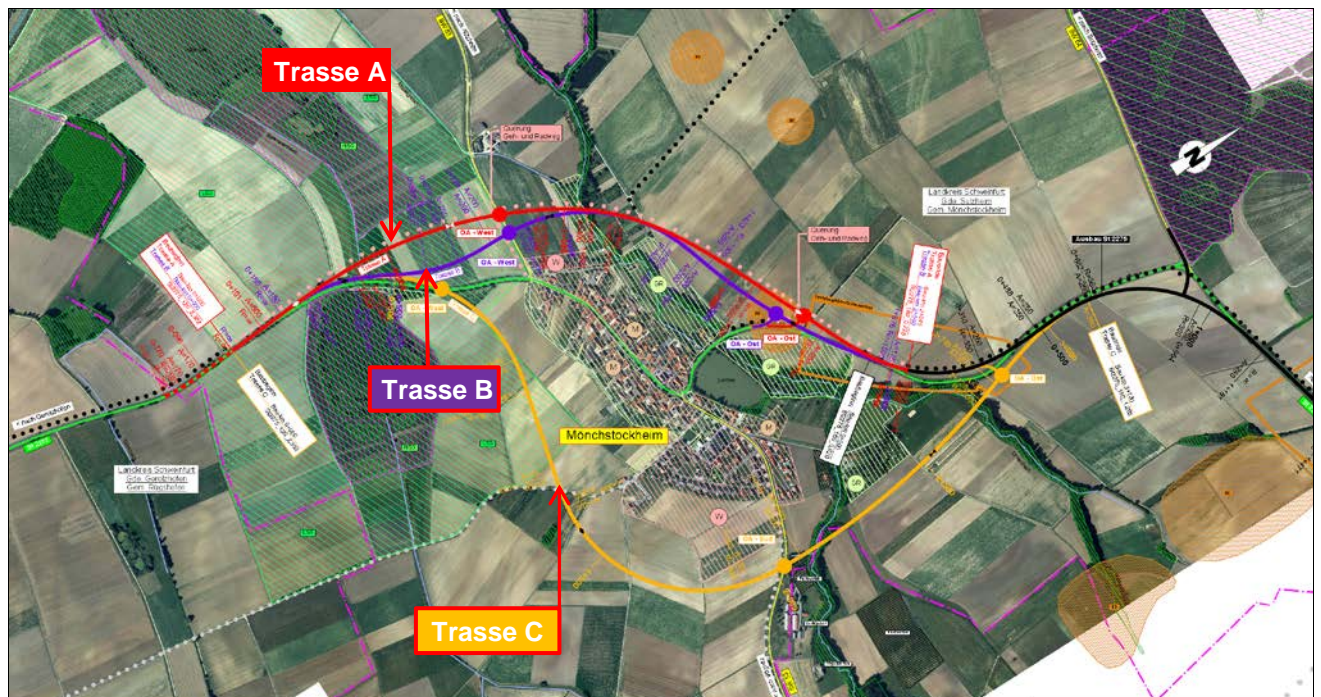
Trassen-Varianten für eine Umfahrung westlich und östlich von Mönchstockheim
